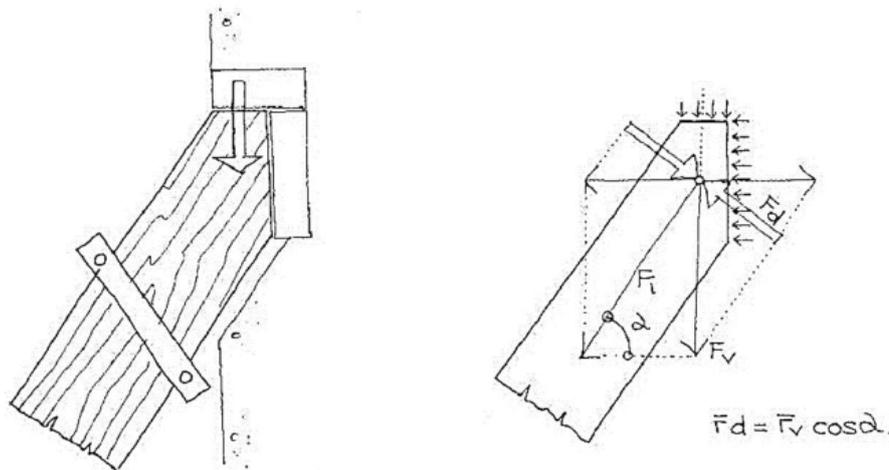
Solución correcta evitando el esfuerzo a hienda.
